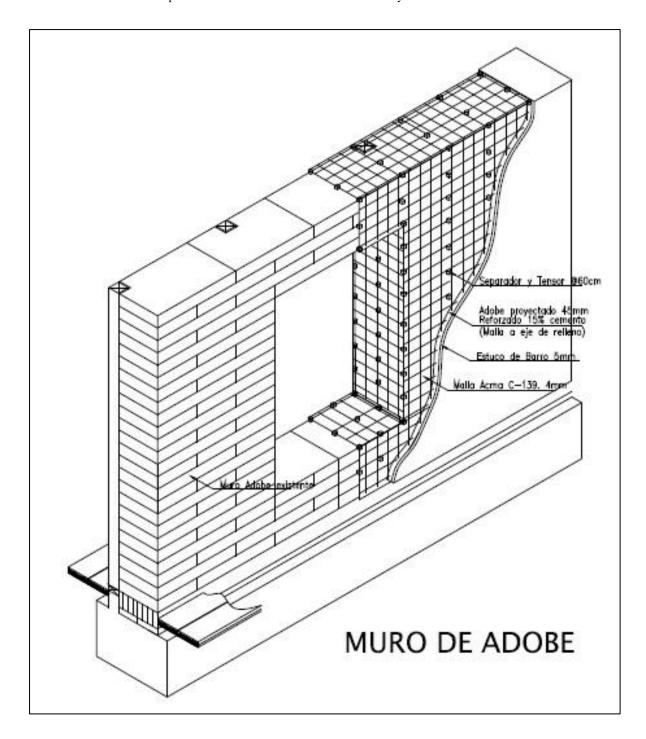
Proceso de reparación vivienda. Fuente: Proyecto reconstrucción EGIS PLANING S.A
